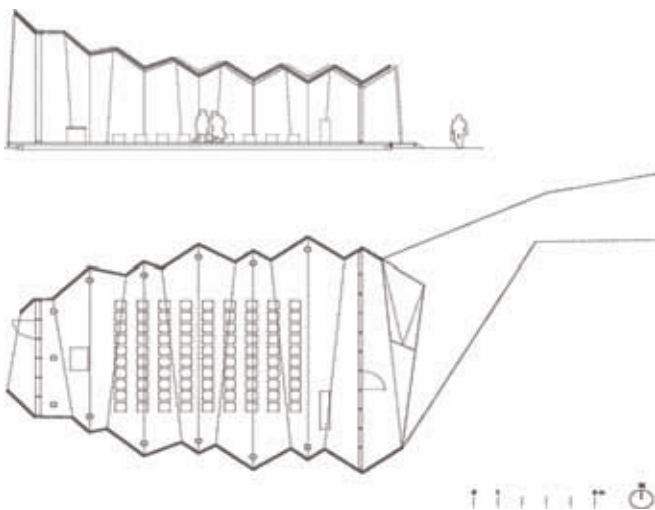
(a sinistra). Cappella a St.Loup: pianta e sezione.
